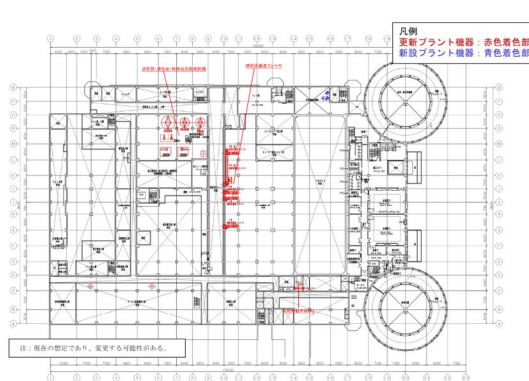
(3) 設備機器の更新箇所 (3 階平面図)
